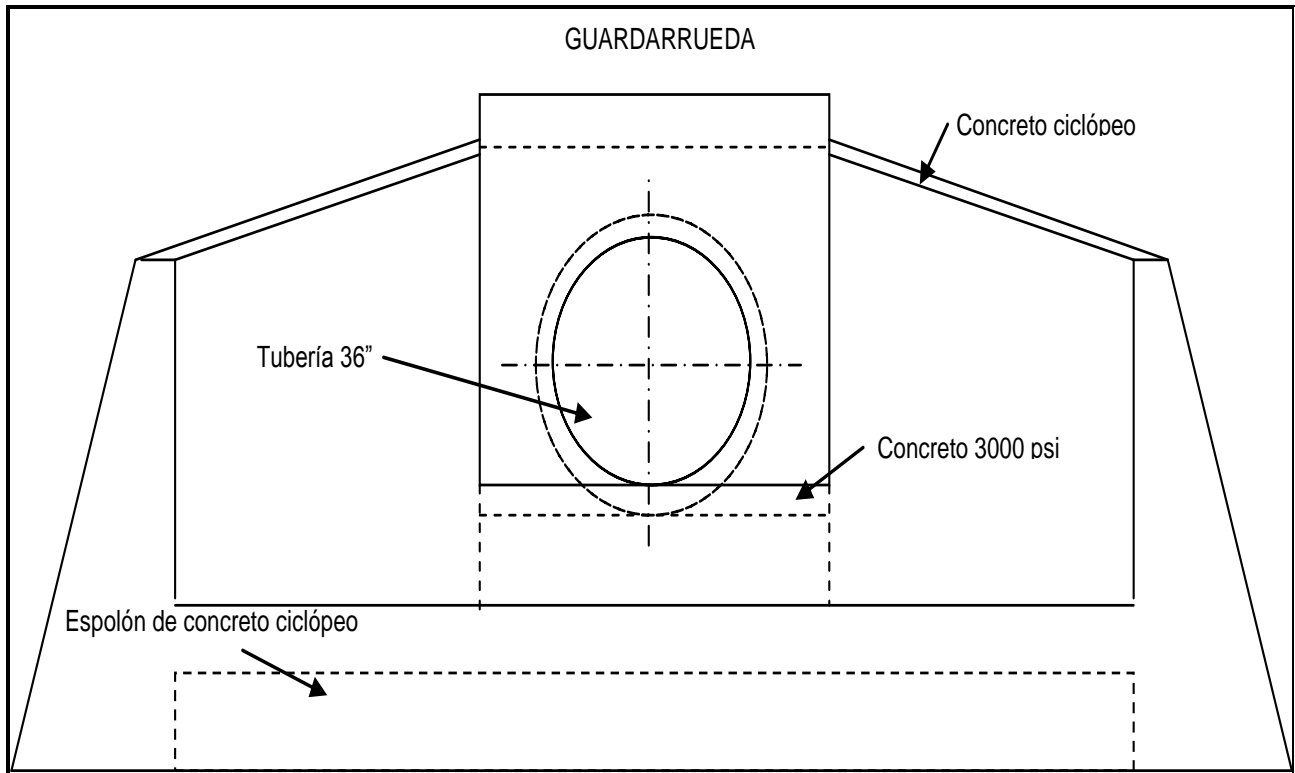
10: Vista frontal y lateral de una alcantarilla tipo para las vías de acceso.
